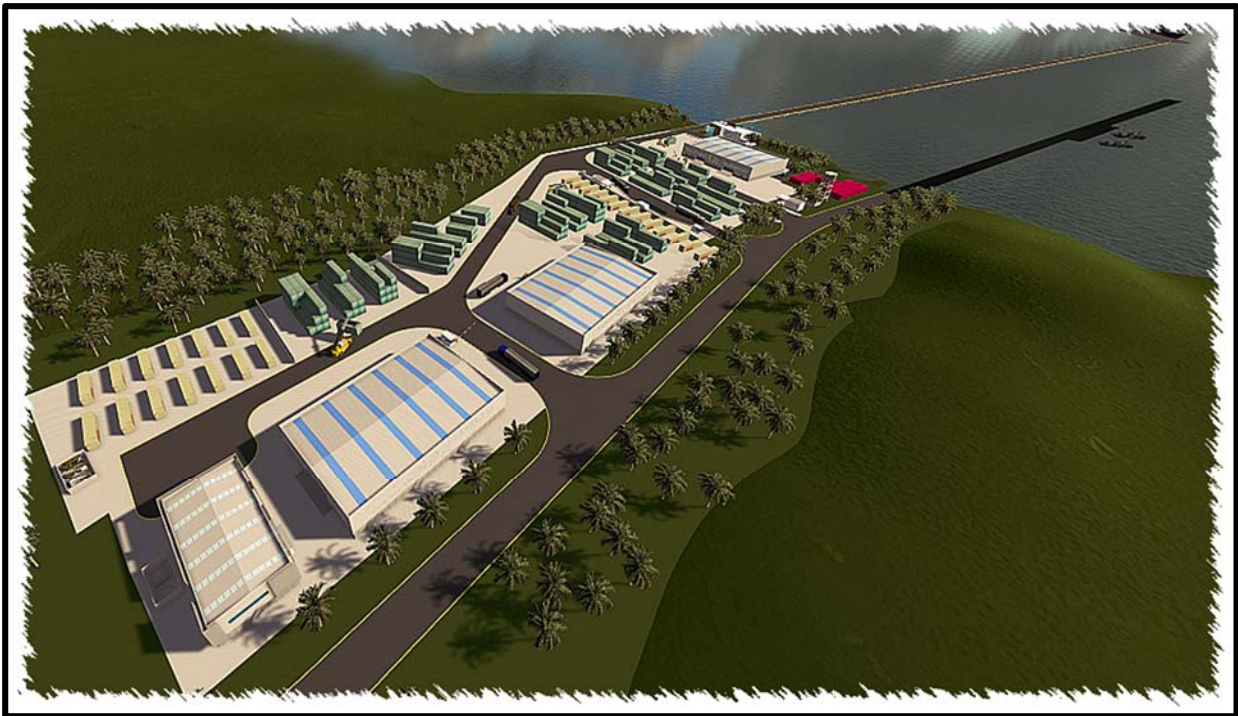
Planta conjunta Dirección General de Migración y Extranjería
